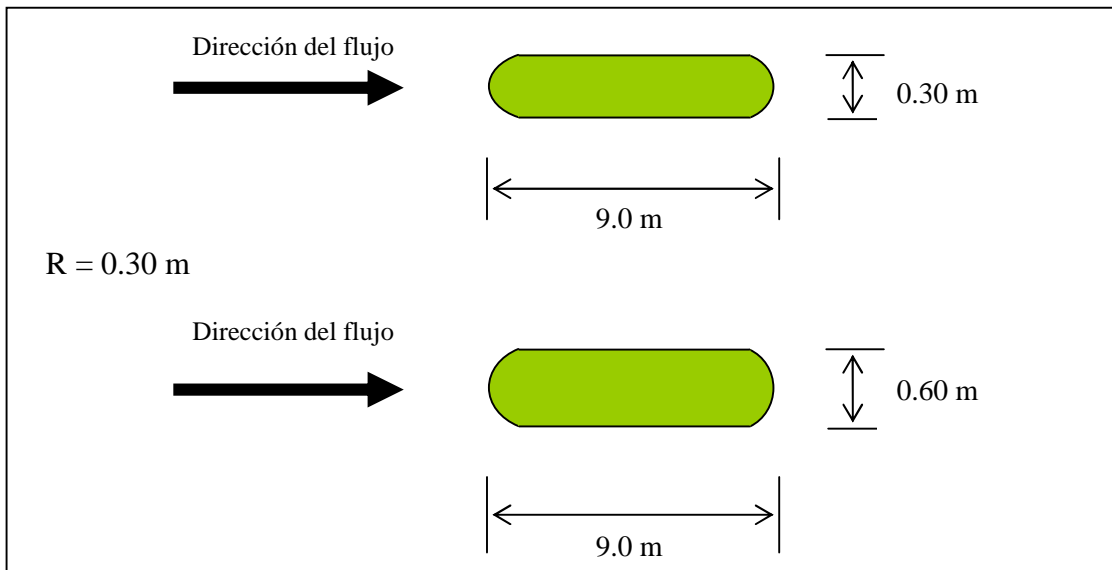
Sección del pilar del Puente Aguas Verdes, carretera Panamericana Norte
